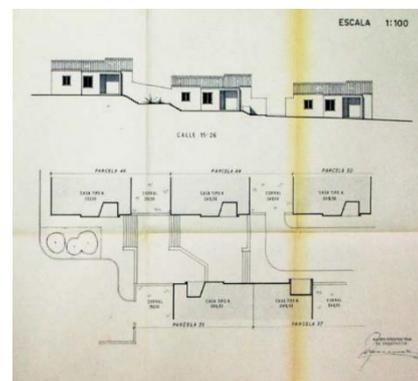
Tipo A. Detalle de planta y alzado de la calle.
